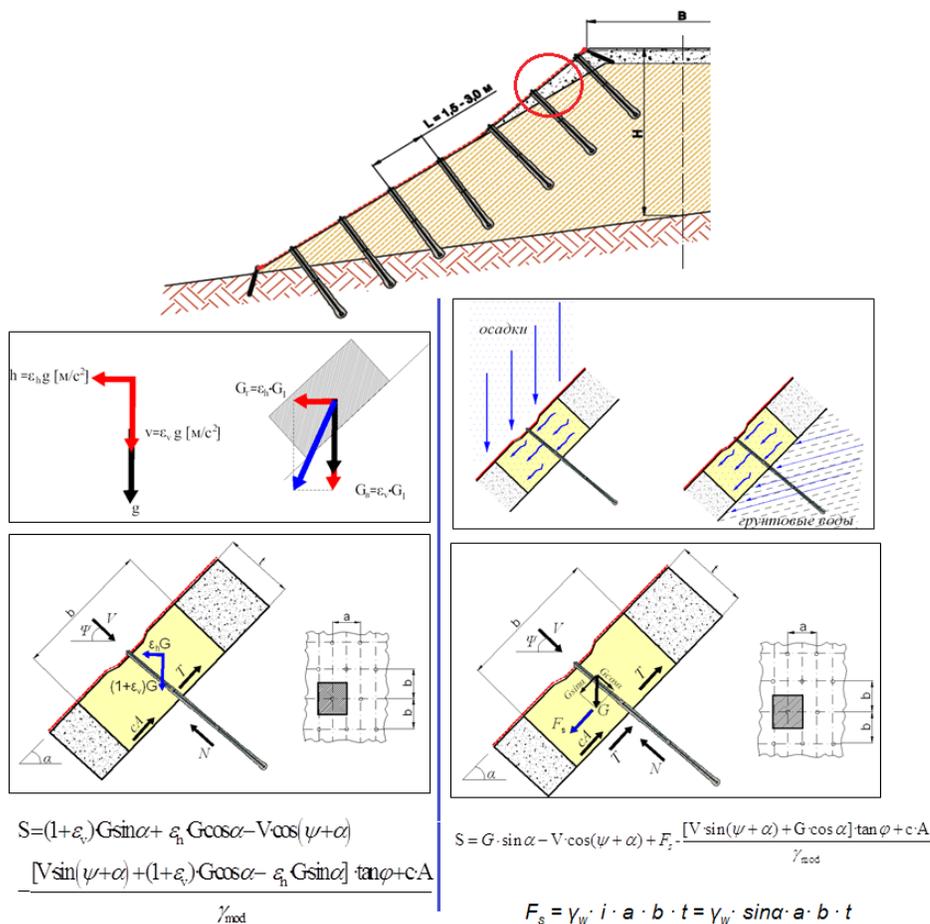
Расчётные схемы для усиления земляного полотна железных дорог анкерными и нагельными конструкциями.
